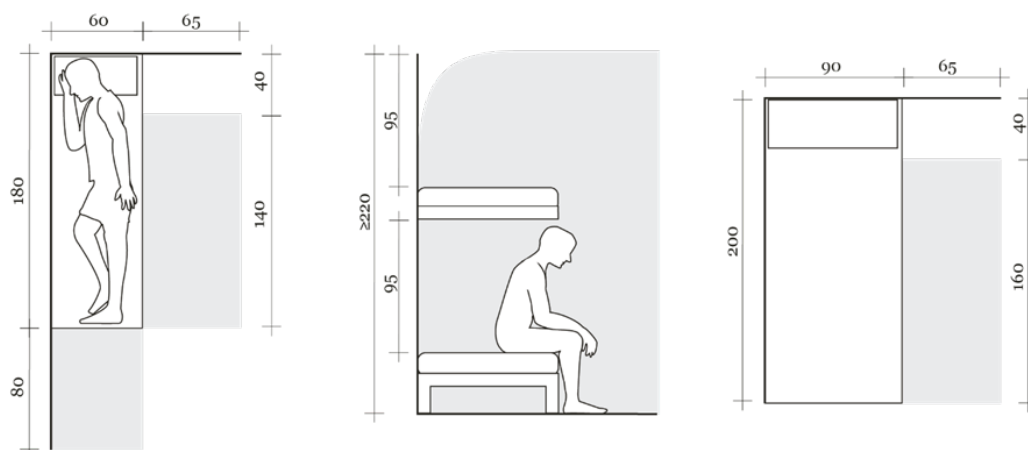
Ergonomía en zona de descanso. Fuente: (Panero & Zelnik, 1996). Elaboración: Autores.
